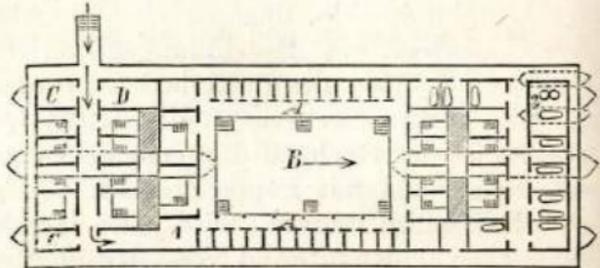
Thiebe'sche schwimmende Badeanstalten im Rhein zu Bonn (Grundriss des Damenbadeschiffs).
